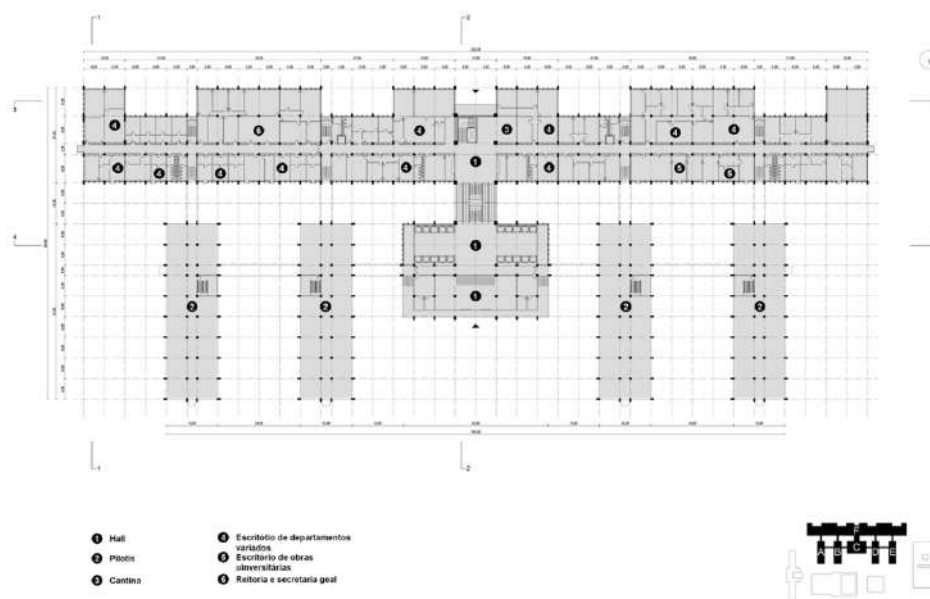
Pavilhão João Lyra Filho - Planta Baixa Térreo.
